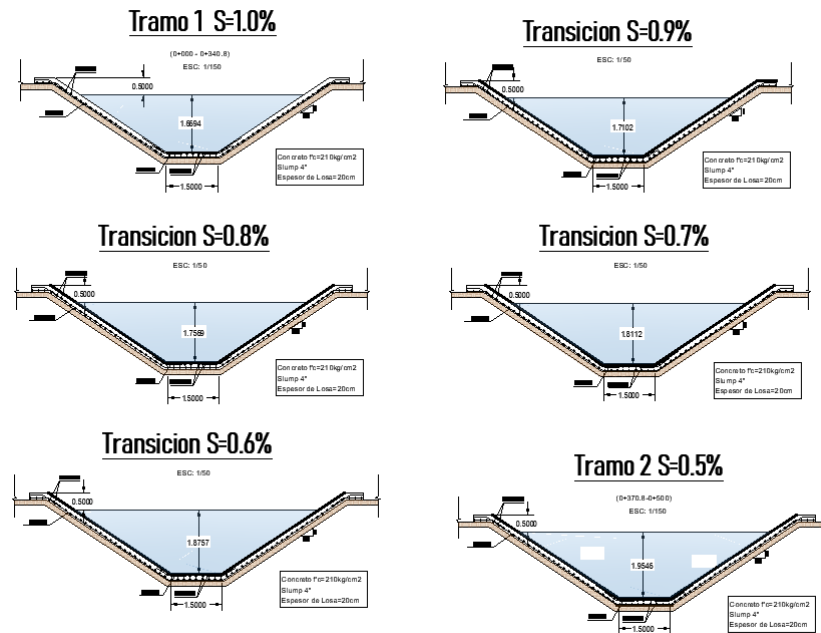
Secciones diseñadas de canal revestido con geoceldas rellenas de concreto. Elaboración propia.
